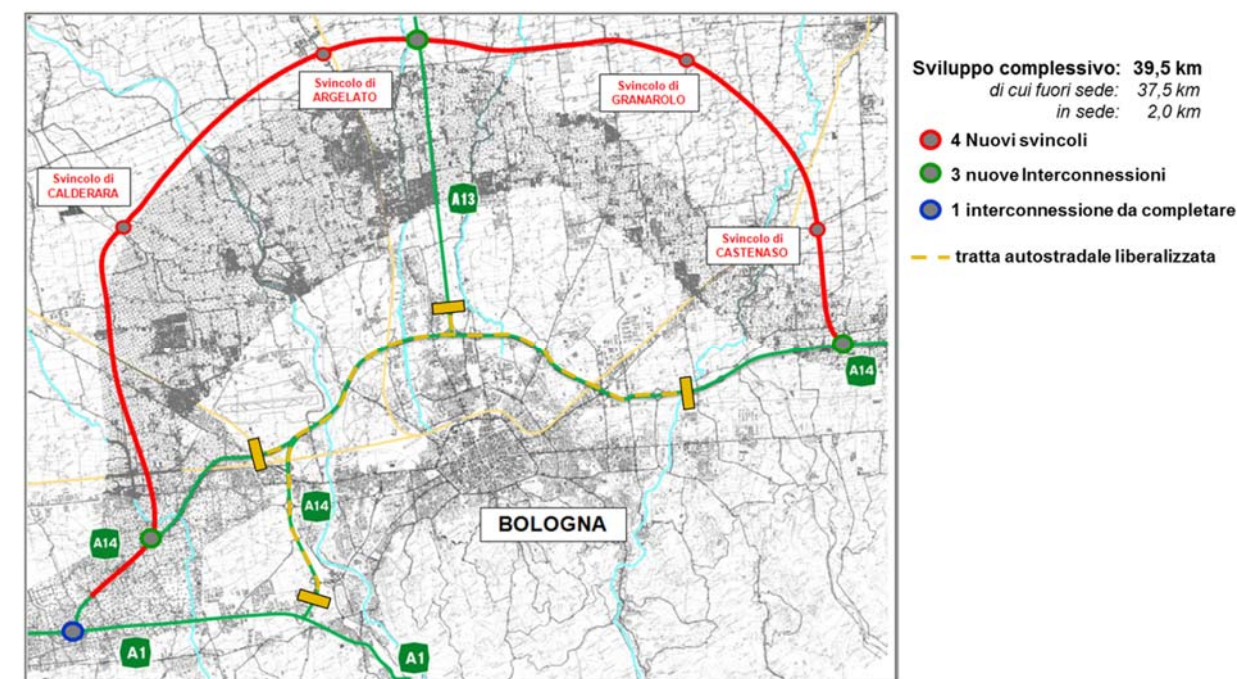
Schema di progetto del Passante Nord (fonte: Progetto preliminare)
